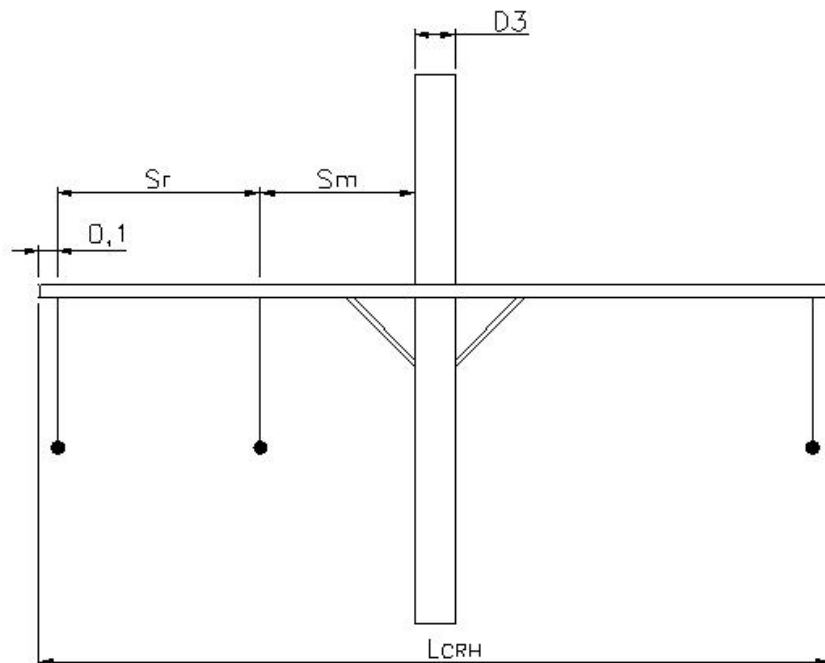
Disposición de línea eléctrica simple terna horizontal.
